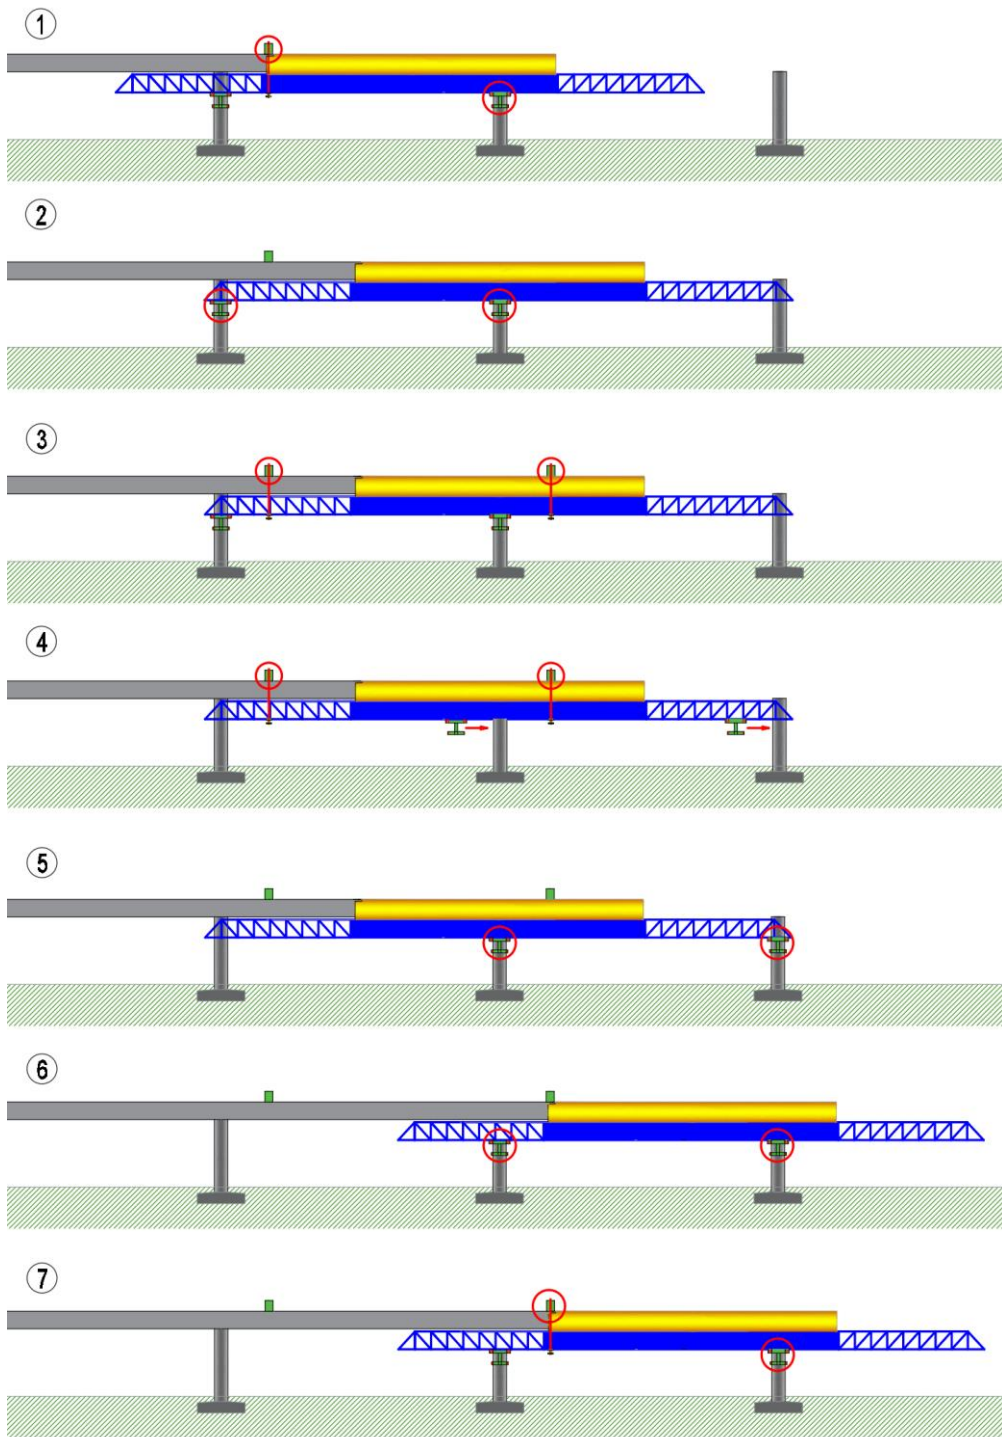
Hlavné časti výsuvnej skruže s dolným trámom
